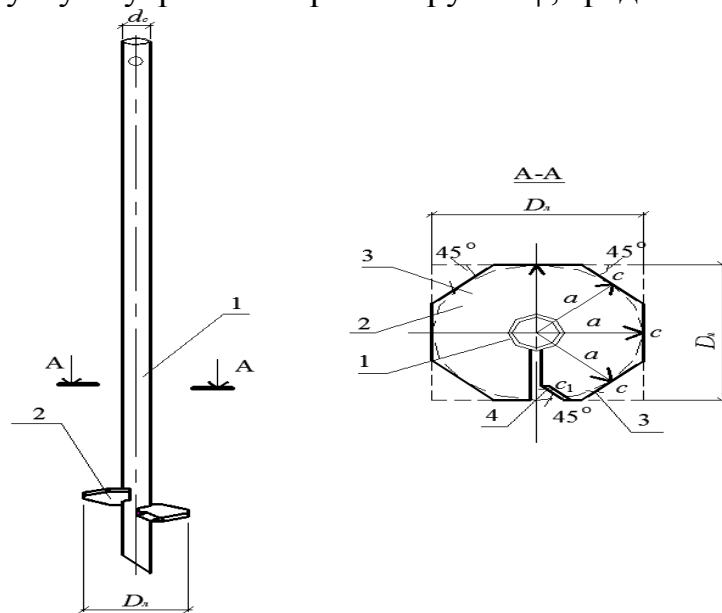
Конструкция разработанной мелкозаглубленной винтовой металлической сваи
